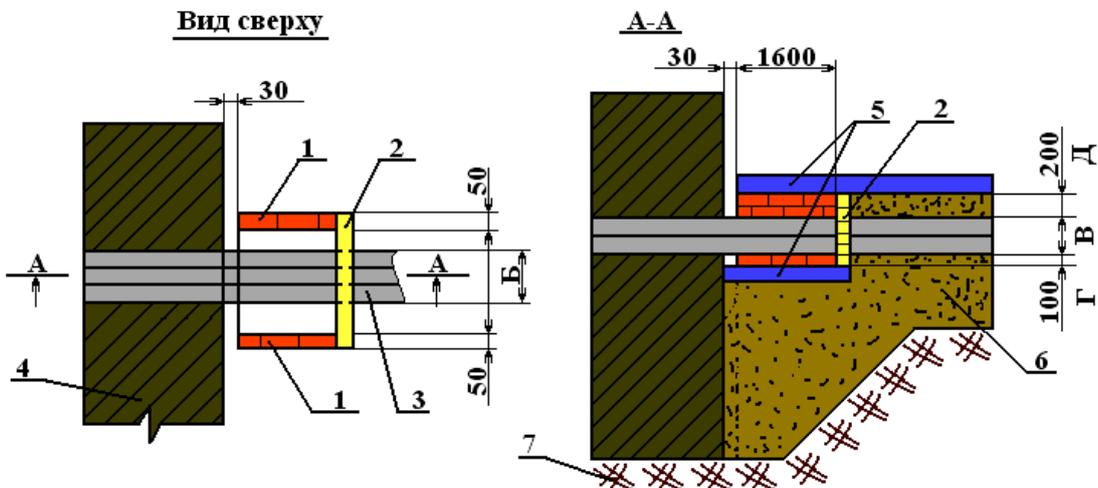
Защита трубы при выходе из фундамента в грунт
